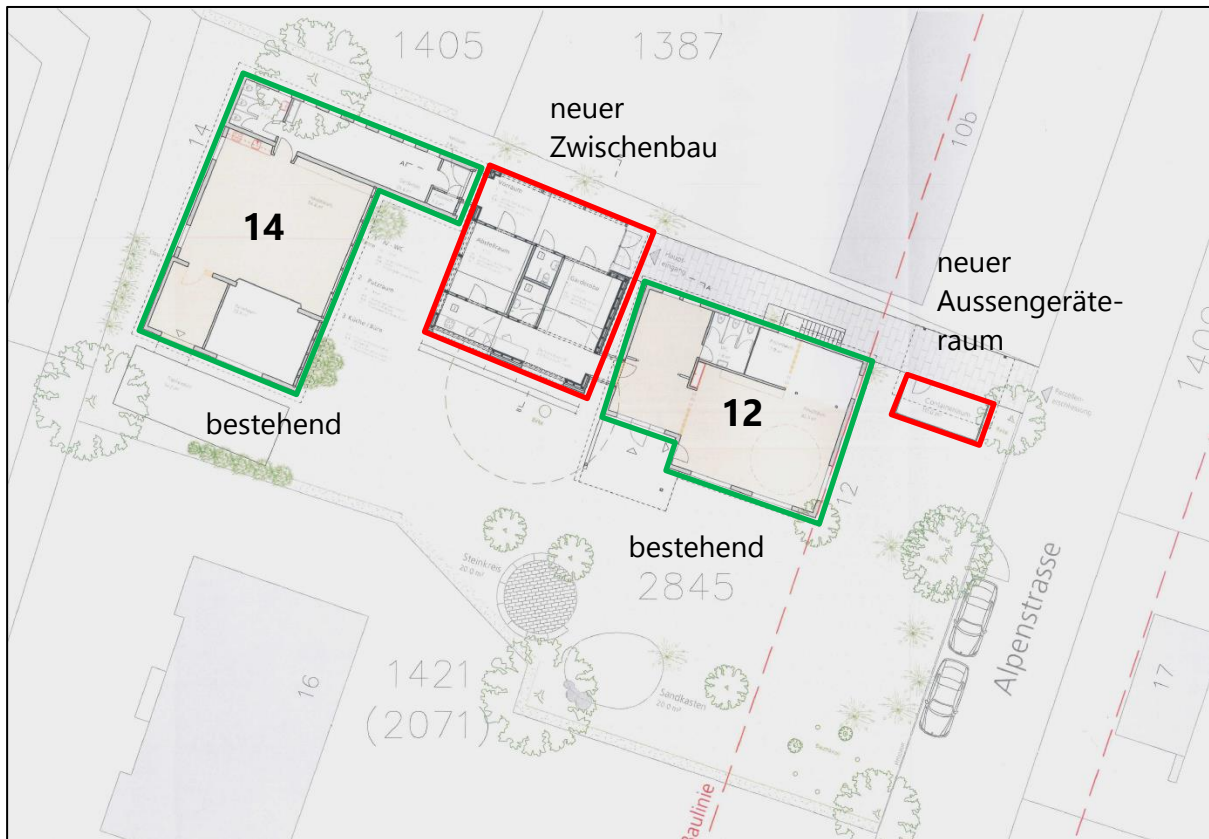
Situationsplan Doppelkindergarten Alpenstrasse 12/14 (Projektstand 2014)
